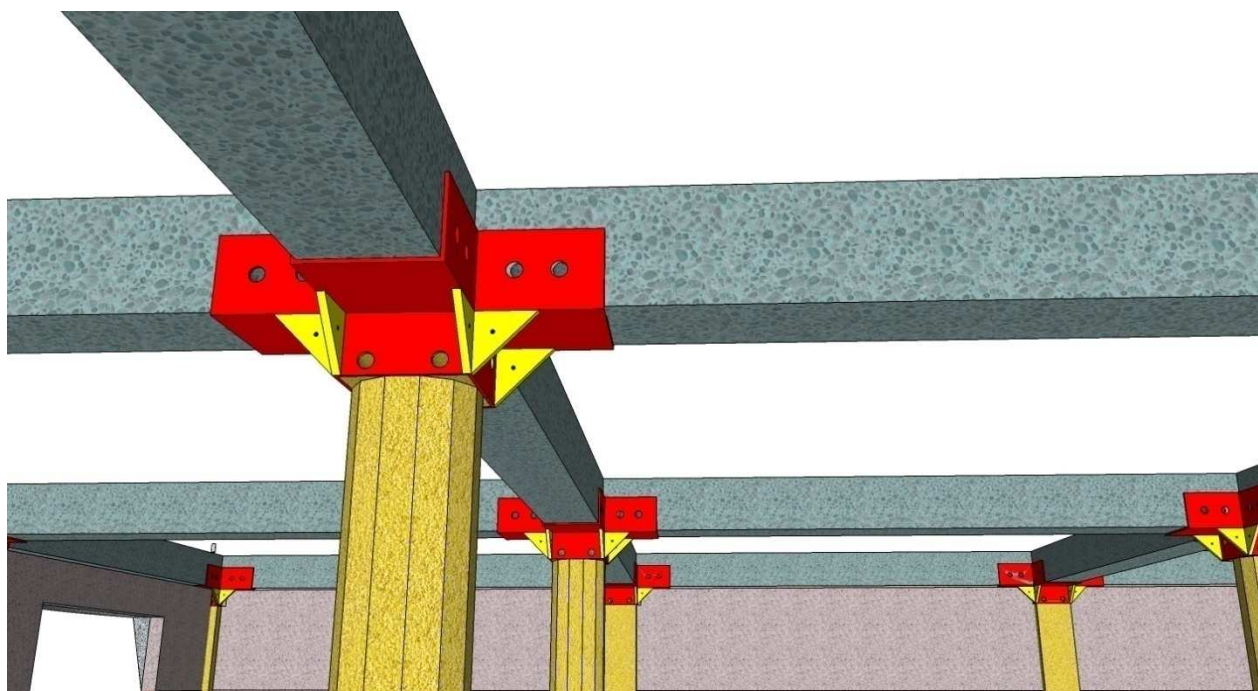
vue de bas en haut exposant l'assemblage des poutres et poteau avec le nœud
